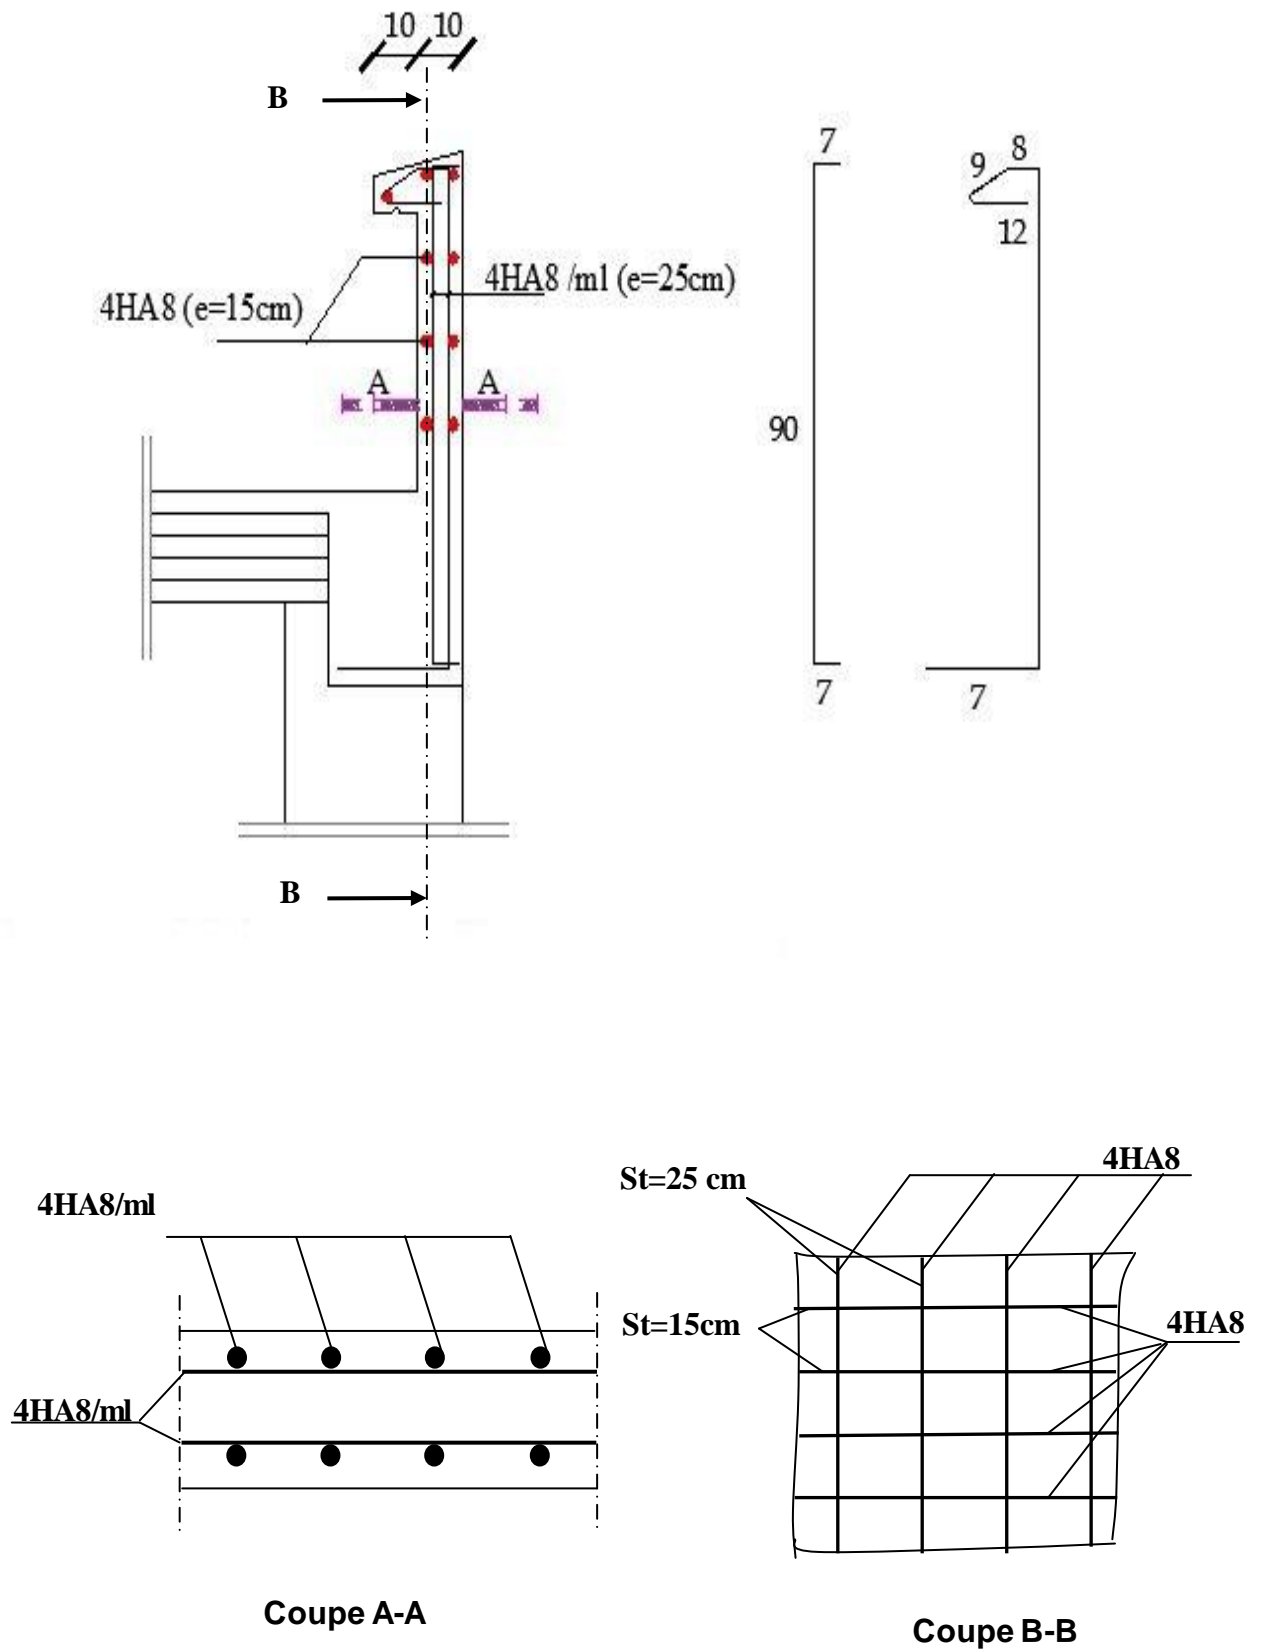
Plan de Ferrailage de l'acrotère.
